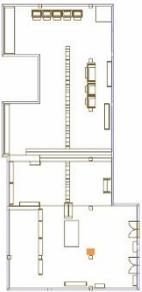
21 Layout titik lampu Ruang Pamer II
